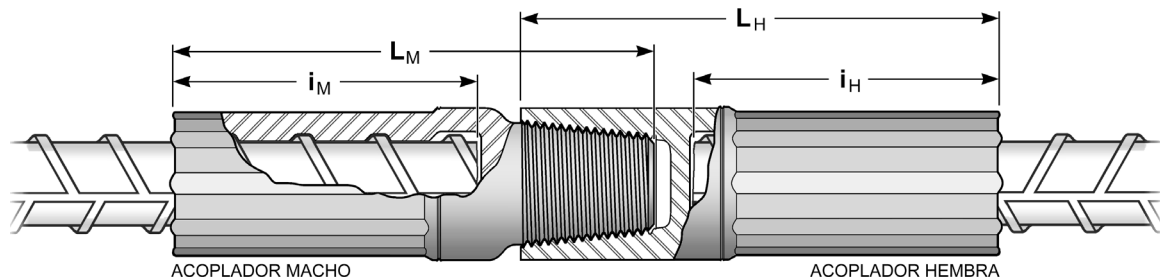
TAPER THREADED GRIP-TWIST®
